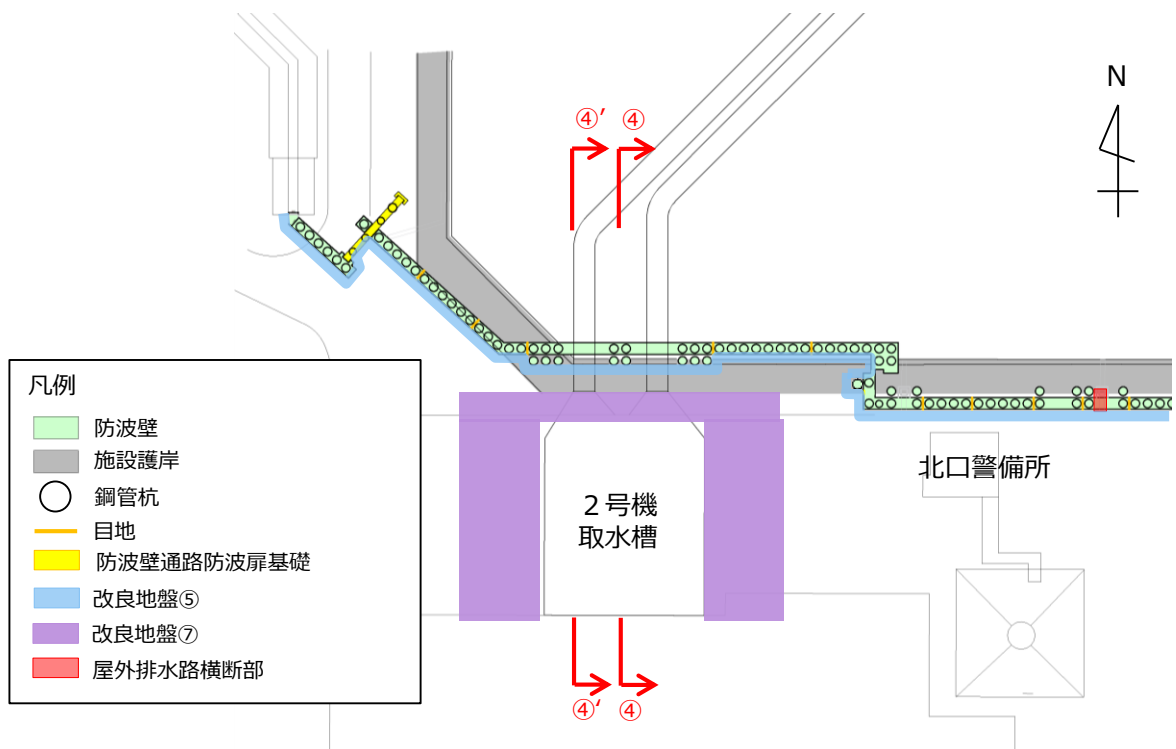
防波壁（多重鋼管杭式擁壁）の④'-④'断面（平面図）
